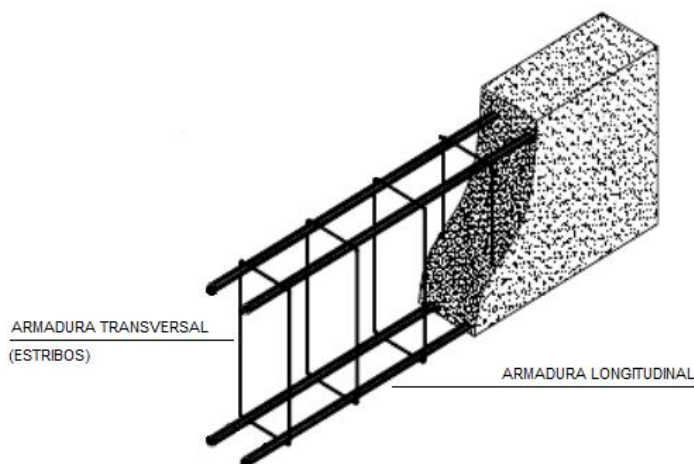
Exemplo de viga de concreto armado. Fonte: Adaptado de Pagnussatti; Silva (2011).
